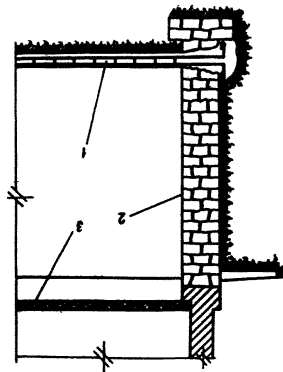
Схема анкерной железобетонной связи-распорки, рекомендуемая при ведении работ без отрыва фундаментов:
